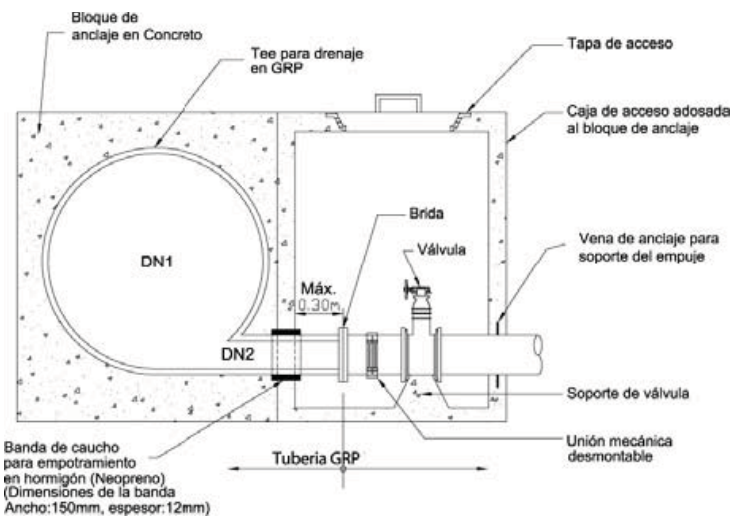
Detalle típico de instalación de válvulas de drenaje y limpieza
